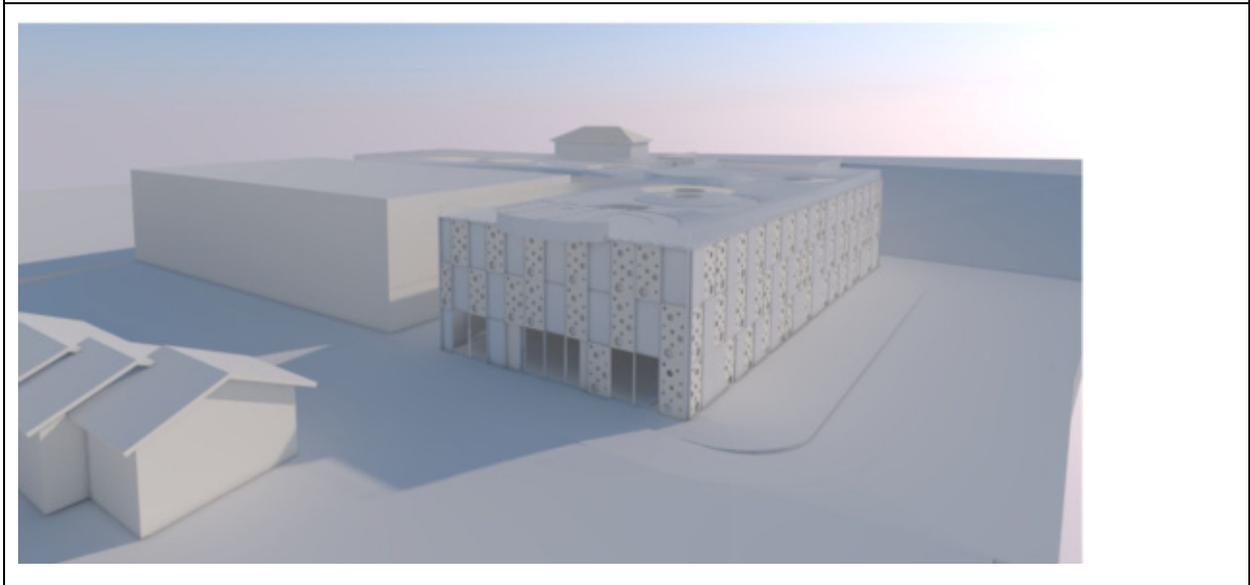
Prospetti e viste prospettiche proposta preliminare di ampliamento
